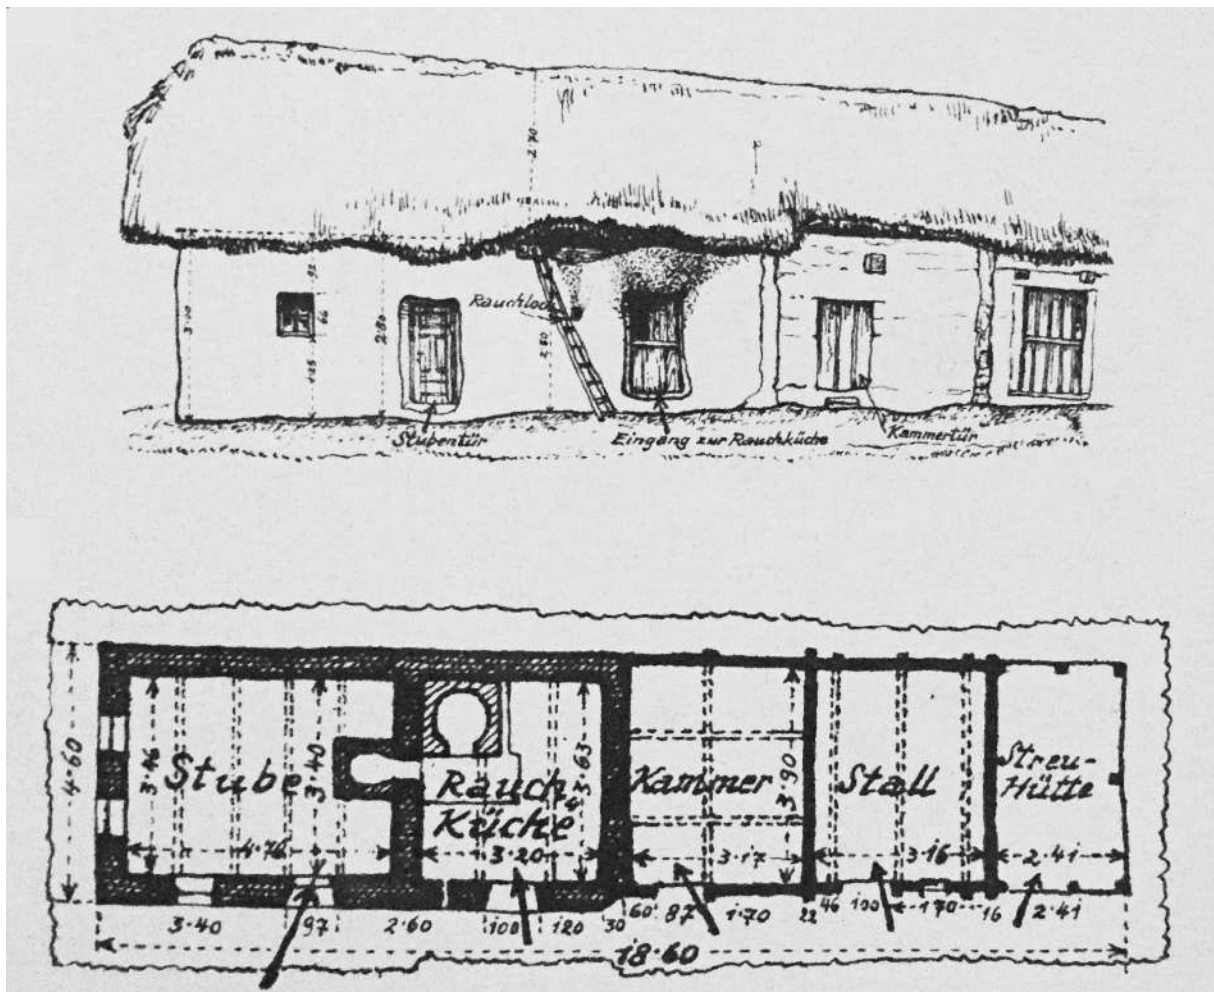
Aufriss und Grundriss eines einfachen Streckhofes, um 1800
